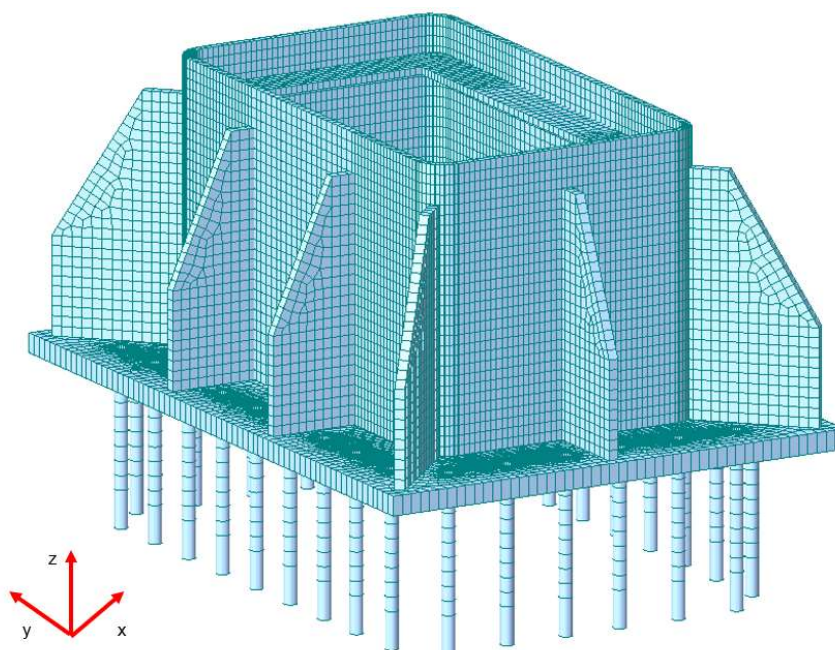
Sistema di riferimento Nodal Loads collegamento alla base
